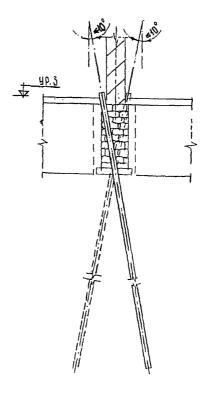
Козловые фундаменты из буроинъекционных свай
